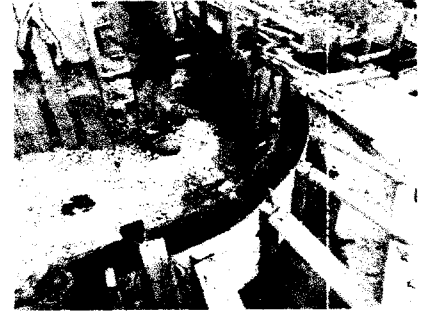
, 64 y 65: Concreto $f'c= 210$ kg/cm², en sardinel para la empezar la fabricación de veredas - Pavimento. PATIO MANIOBRAS
